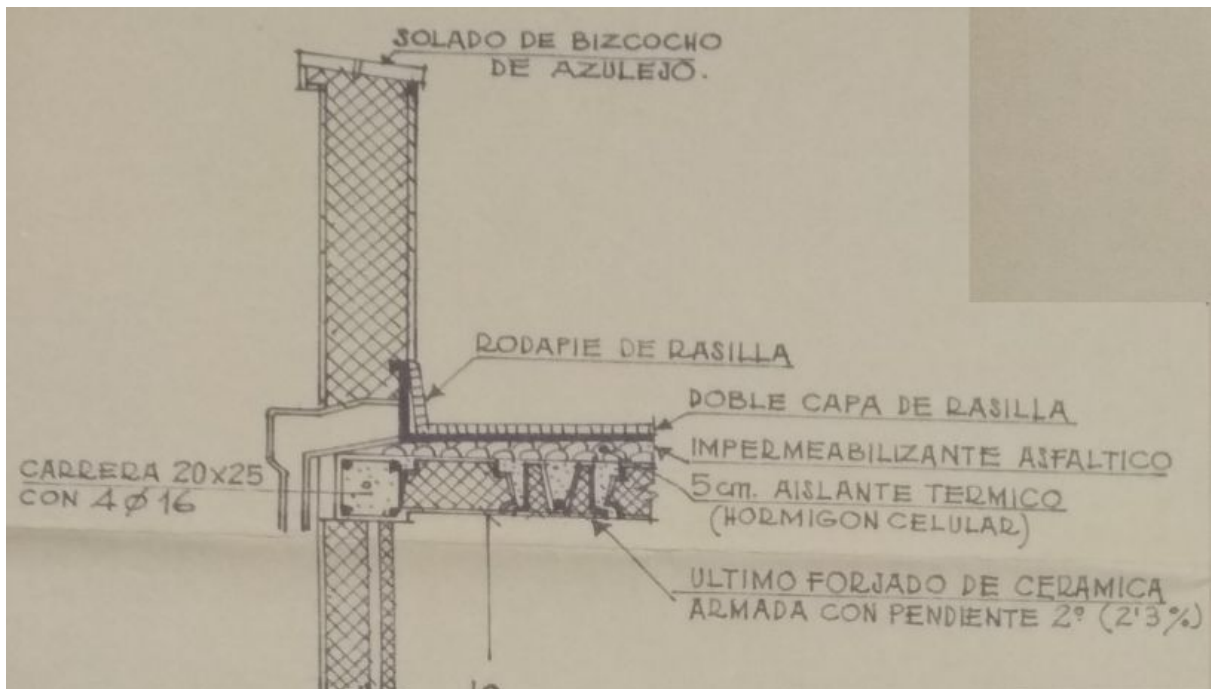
Sección cubierta (Fuente: Ayuntamiento de Castellón de la Plana)
